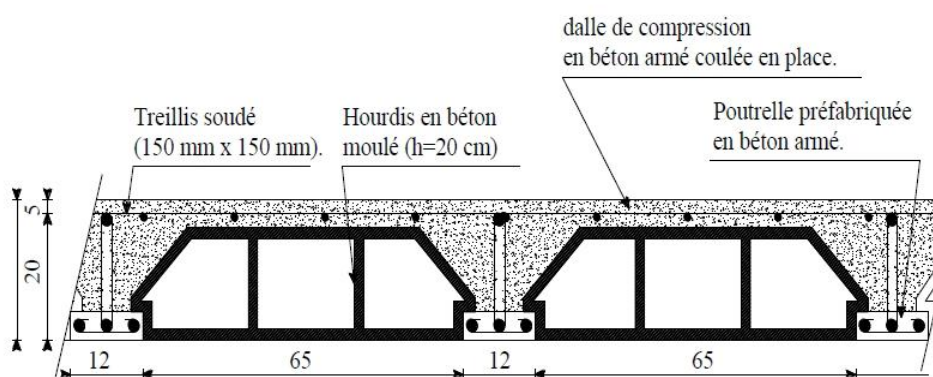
Plancher en béton armé avec poutrelles et hourdis (Plancher semi-préfabriqué)
